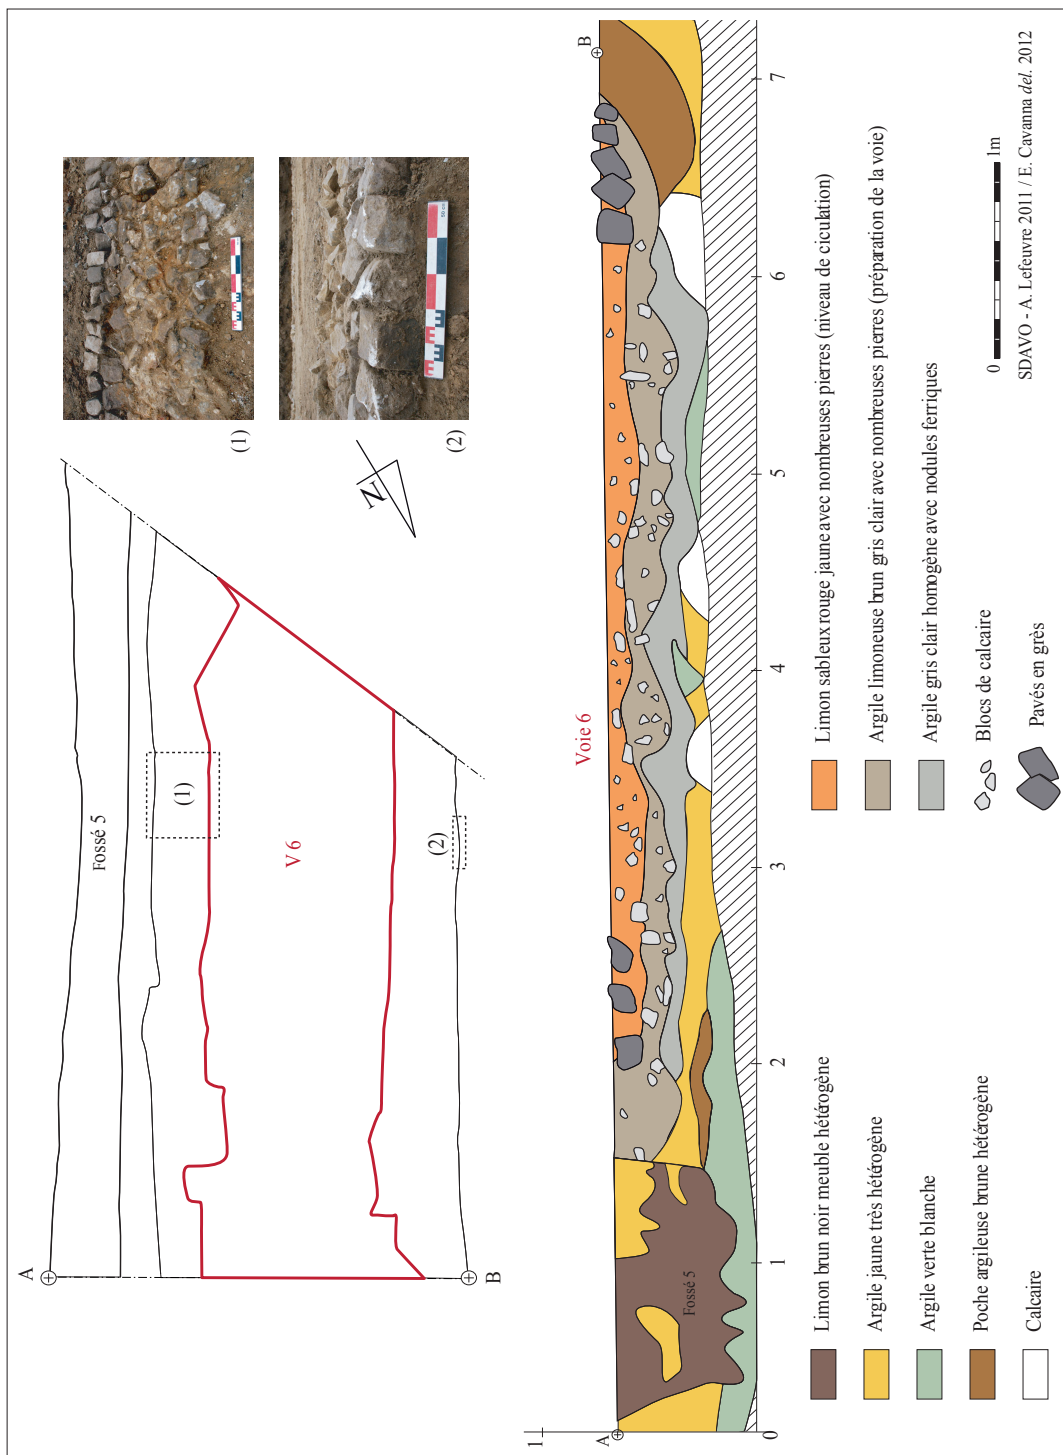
Plan et coupe du chemin de Cormeilles à Courdimanche.
